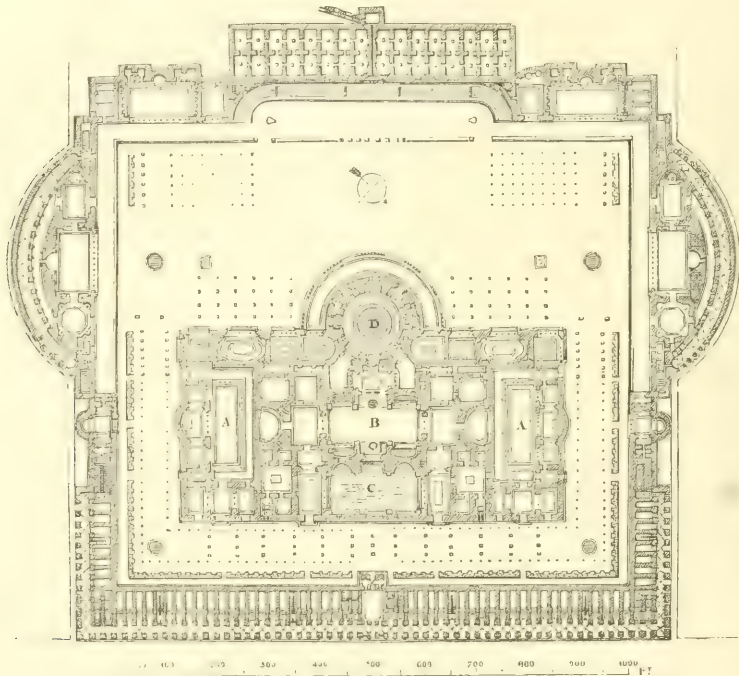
Grundriss der Thermen des Caracalla.
